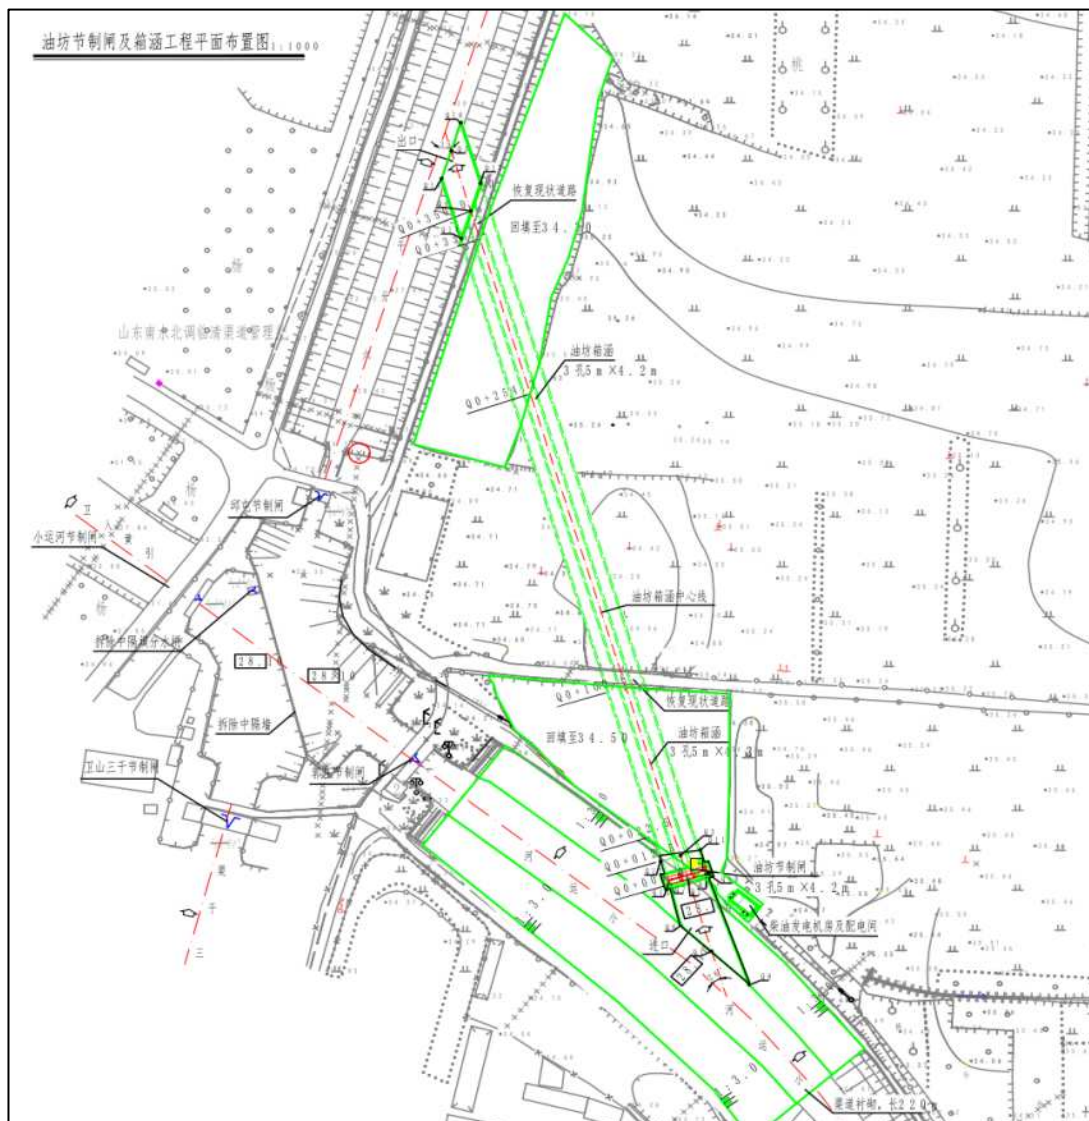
油坊节制闸及箱涵工程总体布置图
